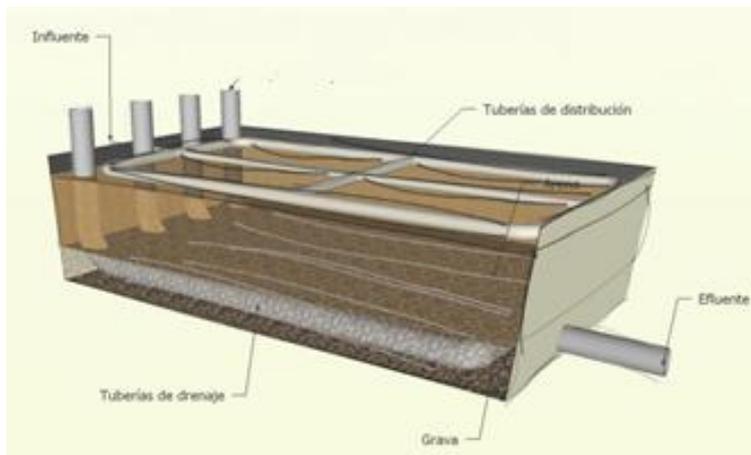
Configuración y distribución de tuberías de HAFSSV.
